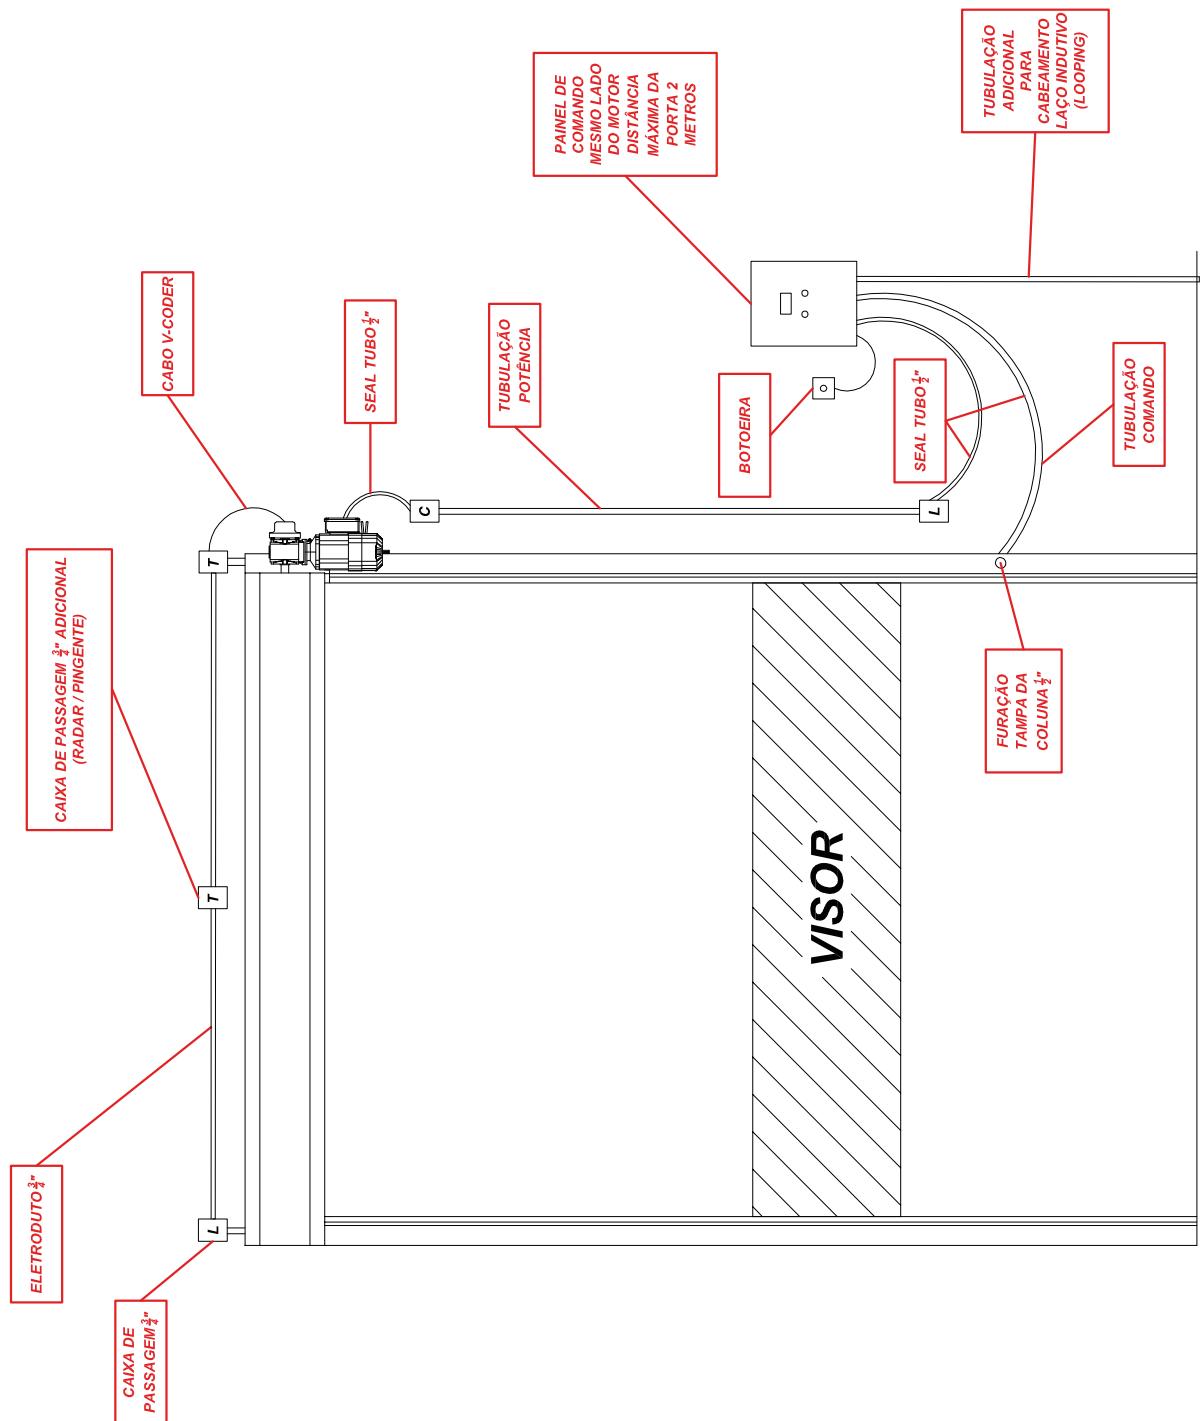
Medidas de cabos e tubulação necessários para a instalação elétrica
